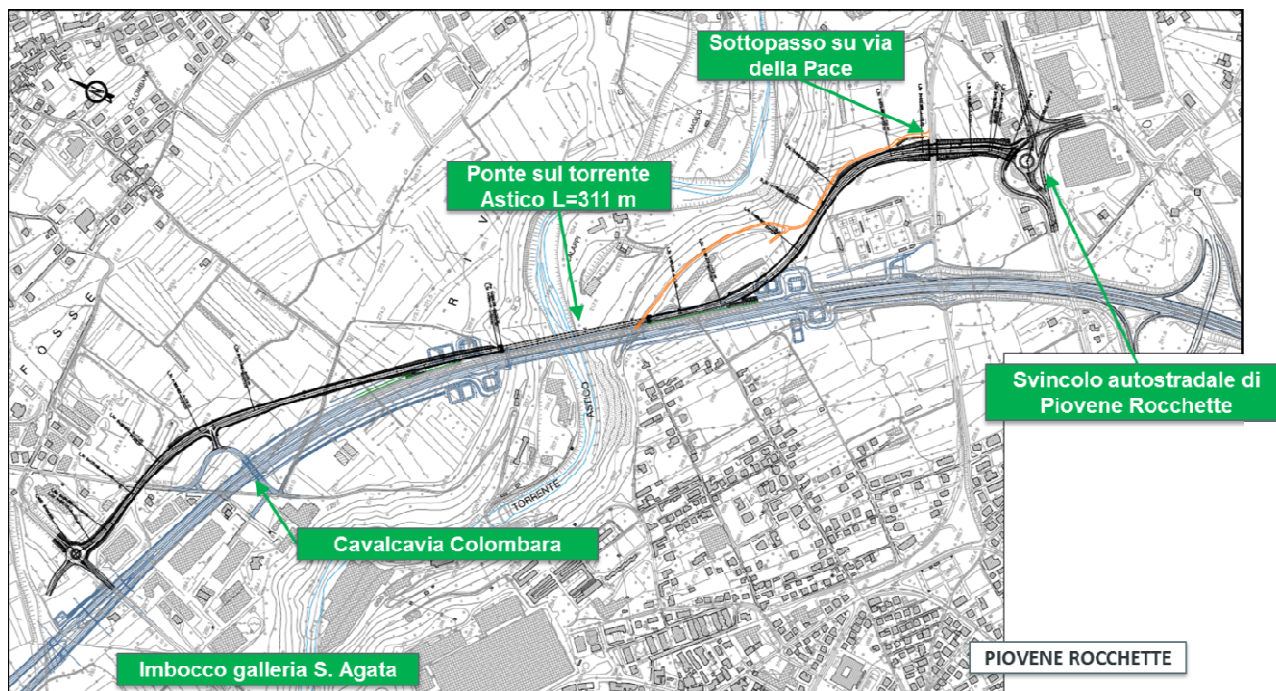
Planimetria della bretella tra Piovene Rocchette e Cogollo del Cengio
